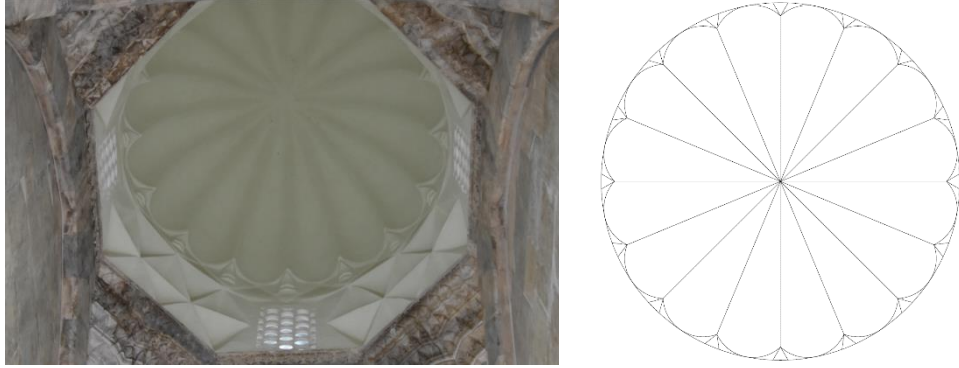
Edirne üç şerefeli Cami'nin Orta Kubbesinin Mukarnaslı Tromp Geçişi, Solda Çizimi.
